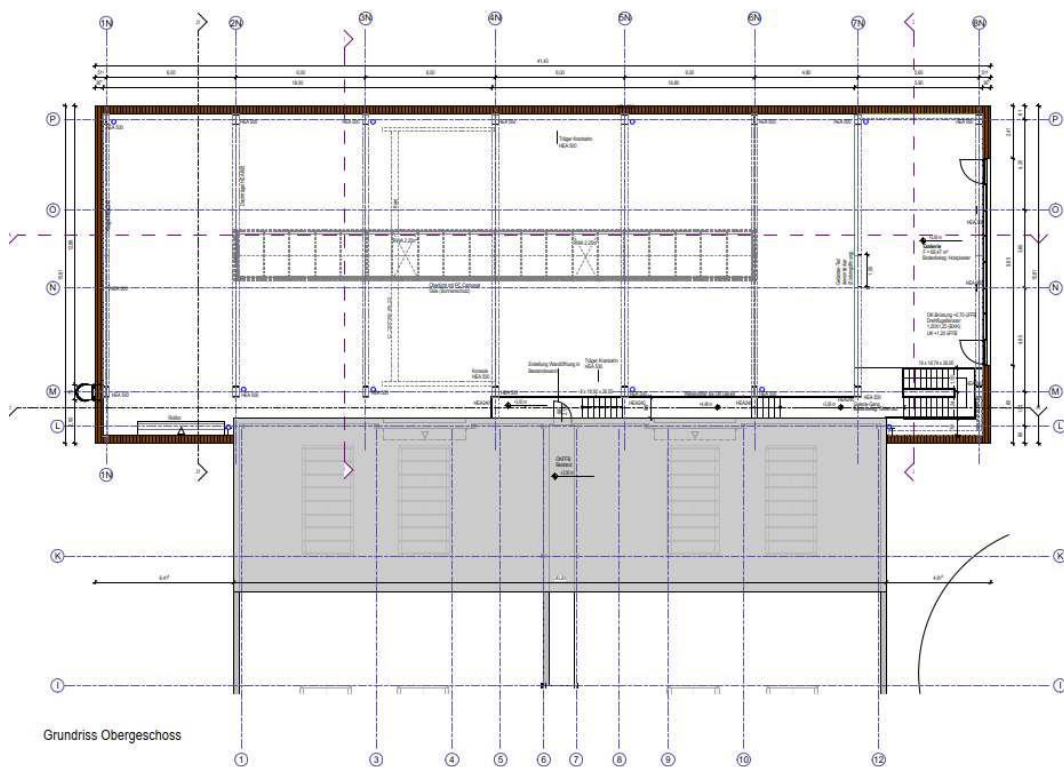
Grundriss Galerie, Quelle: Objektplaner
